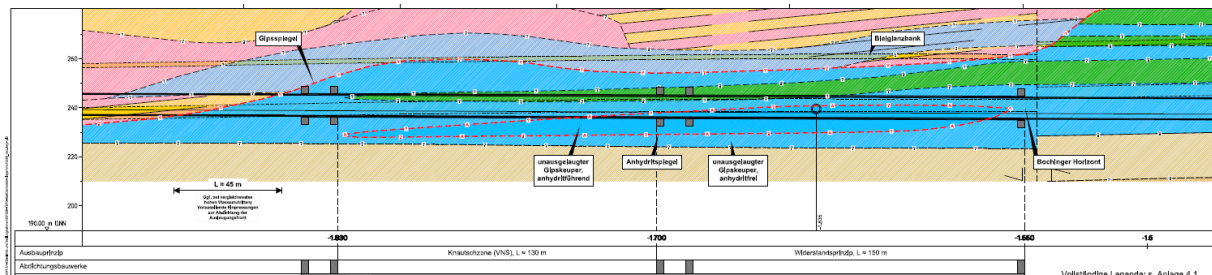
Geotechnischer Längsschnitt Anhydritlinse 1 Tunnel Cannstatt 1); (Bild: Tunnelbautechnisches Gutachten, PFA 1.5 Los 3, WBI)
